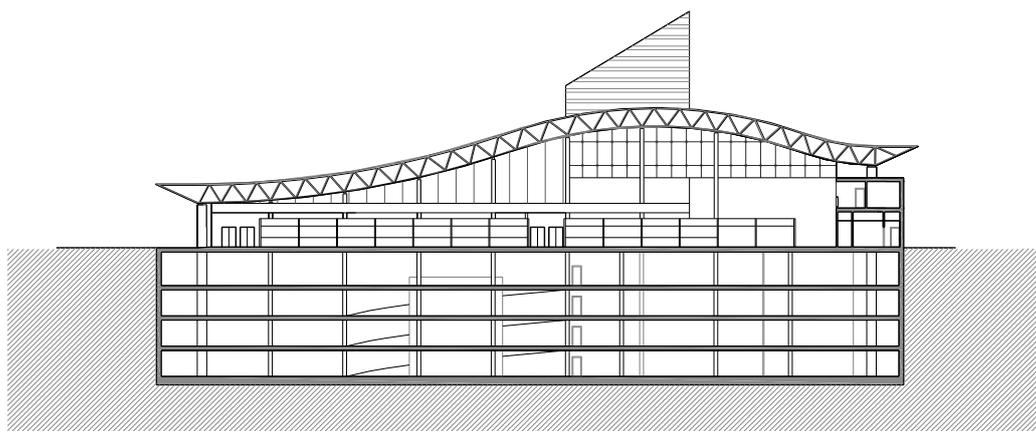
Proyecto primitivo del Mercado de la Pescadería.
